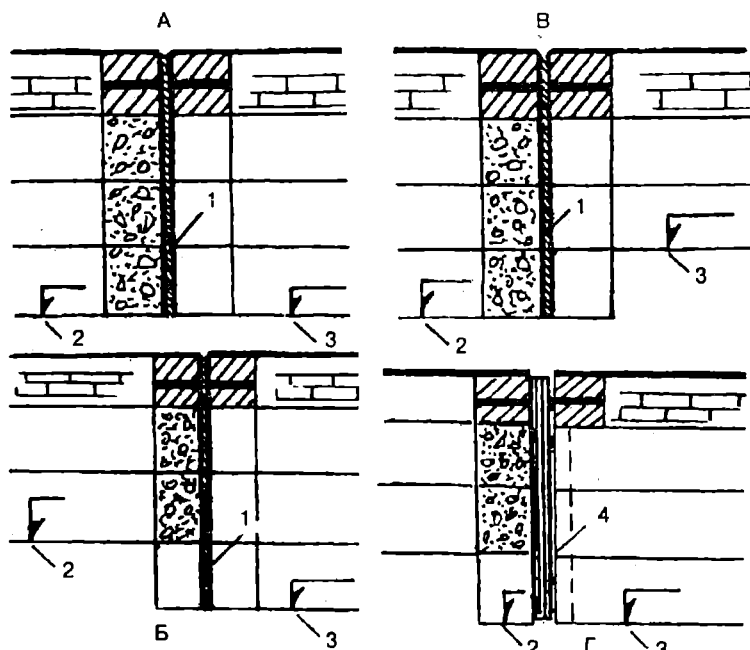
Устройство фундамента рядом с существующим зданием: А — фундаменты на одной отметке; Б — новый пристраиваемый фундамент на более низкой отметке; В — пристраиваемый фундамент на более высокой отметке; Г — оба одноуровневые фундамента имеют шпунтовую стенку (зацеп); 1 — деформационный шов; 2 — отметка основного фундамента; 3 — отметка пристраиваемого фундамента; 4 — шпунтовая стенка (зацеп)
